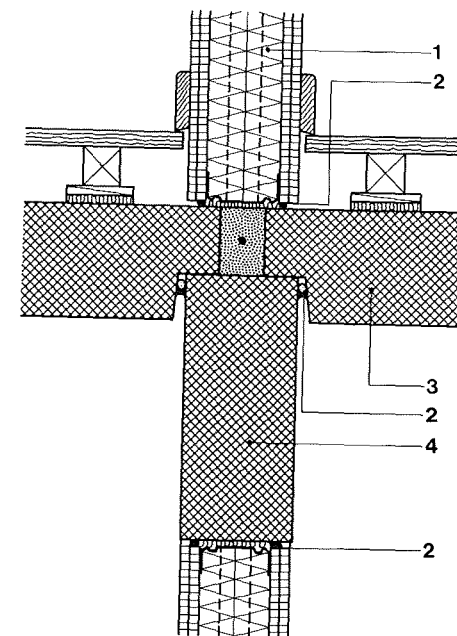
Samling mellem murstensvæg og bærende betonbjælke. Lodret snit 1:10.
